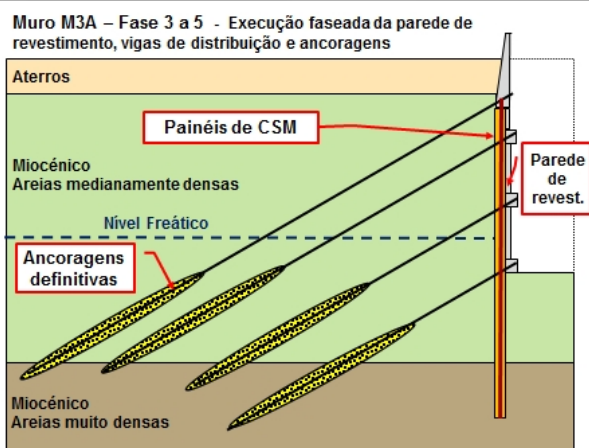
Fase 3 a 5 do faseamento construtivo do Muro M3A
